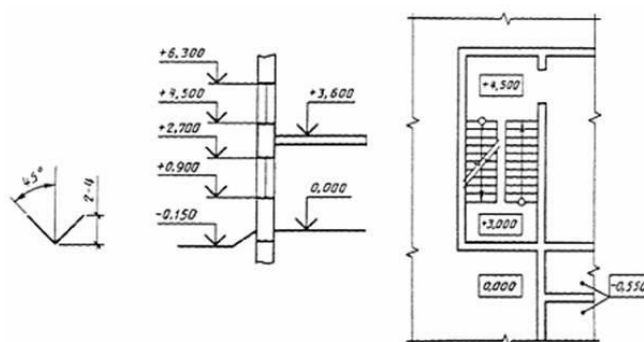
Указание высотных отметок на чертежах фасадов, разрезах, сечениях и планах.
